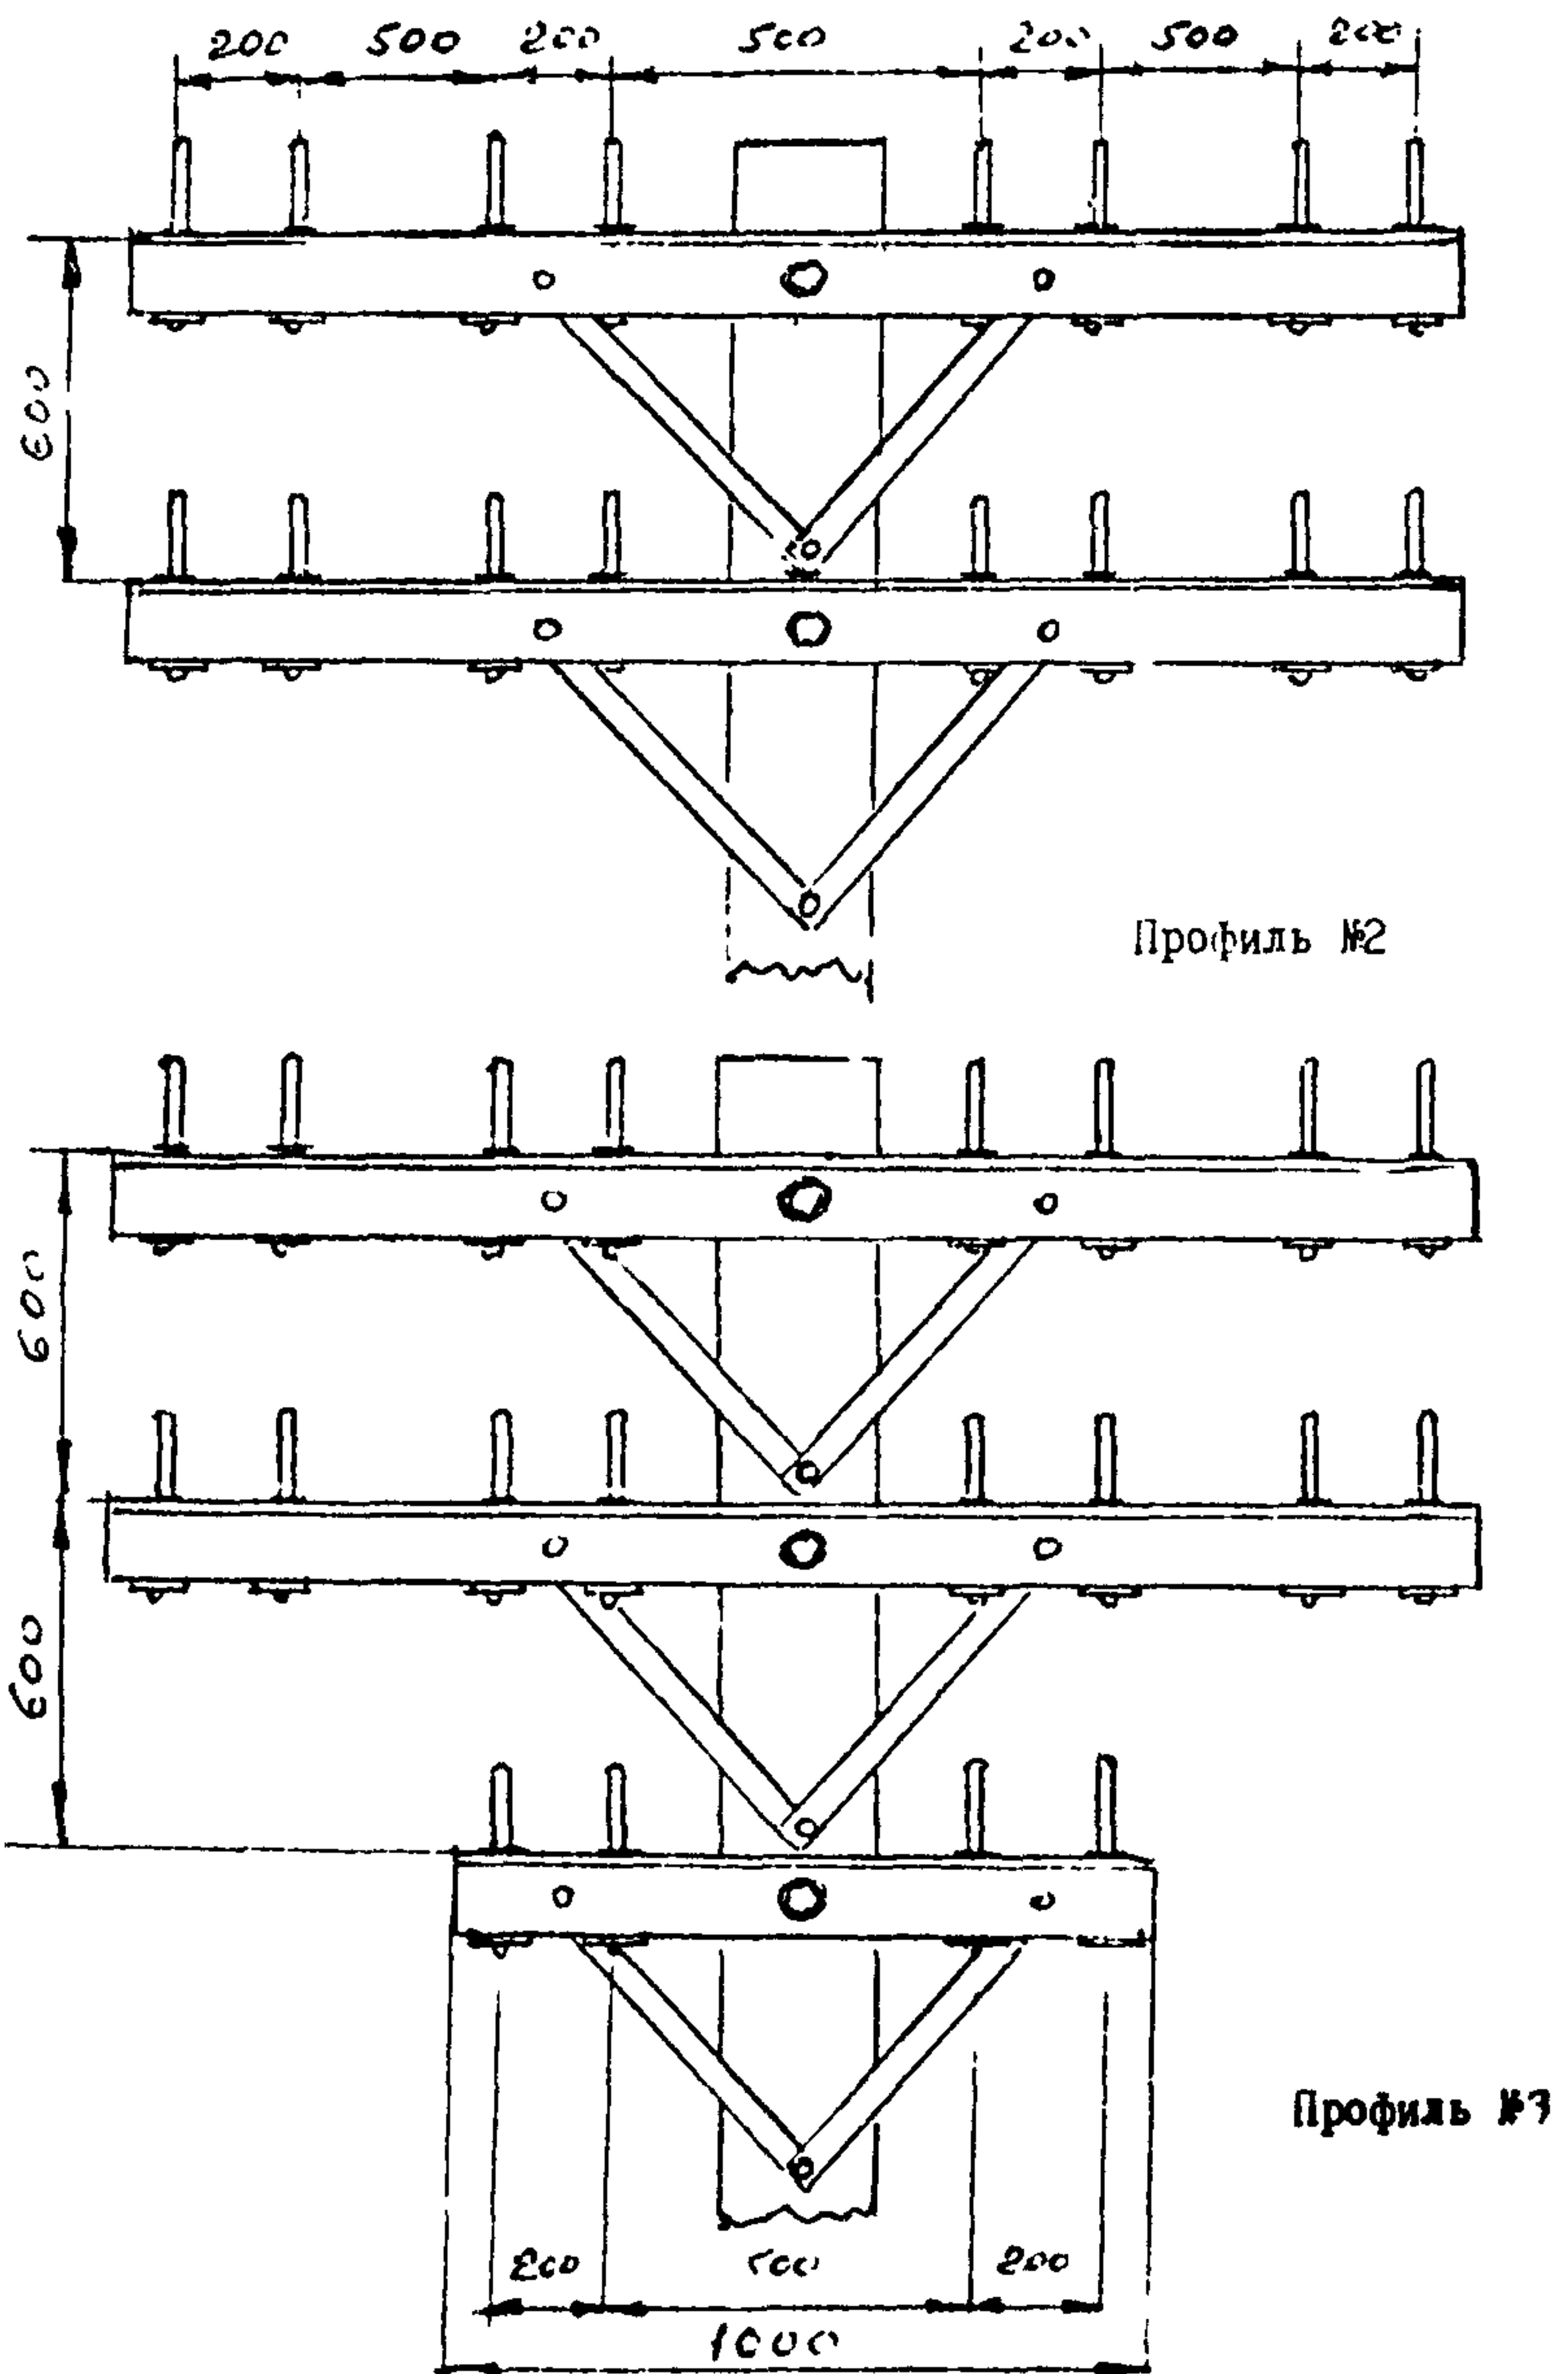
Профили №2 и №3 для линий связи на железобетонных опорах типа ТУ-45-УССР-79
